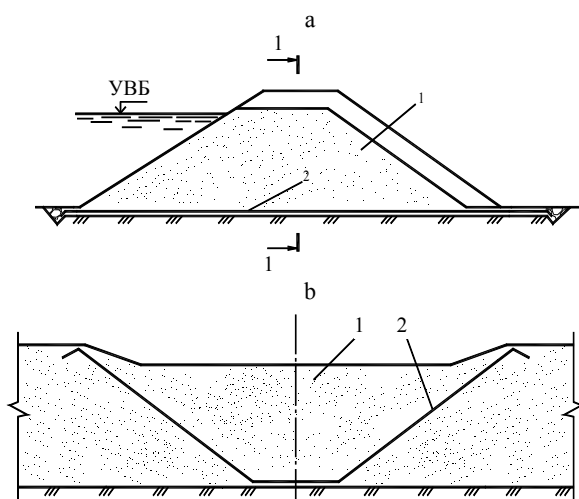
Водосброс с размываемой грунтовой вставкой с ограничивающей размыв одеждой из мягкого полимерного материала: а – поперечный разрез; б – продольный разрез 1–1; 1 – размываемая вставка; 2 – геотекстиль или полимерная пленка; УВБ – уровень верхнего бьефа
